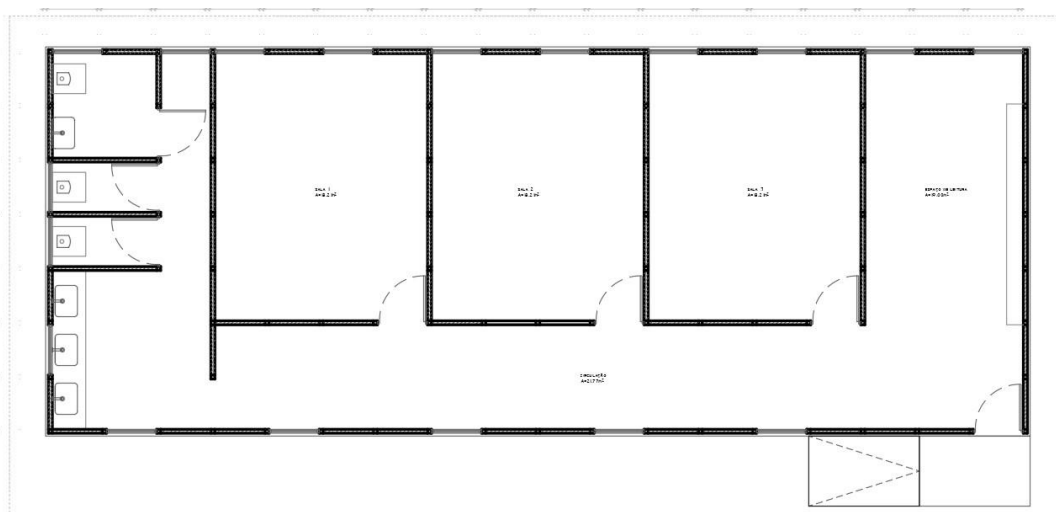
Planta Piso 0 Módulo Salas de Aulas (Fonte: Autor)
